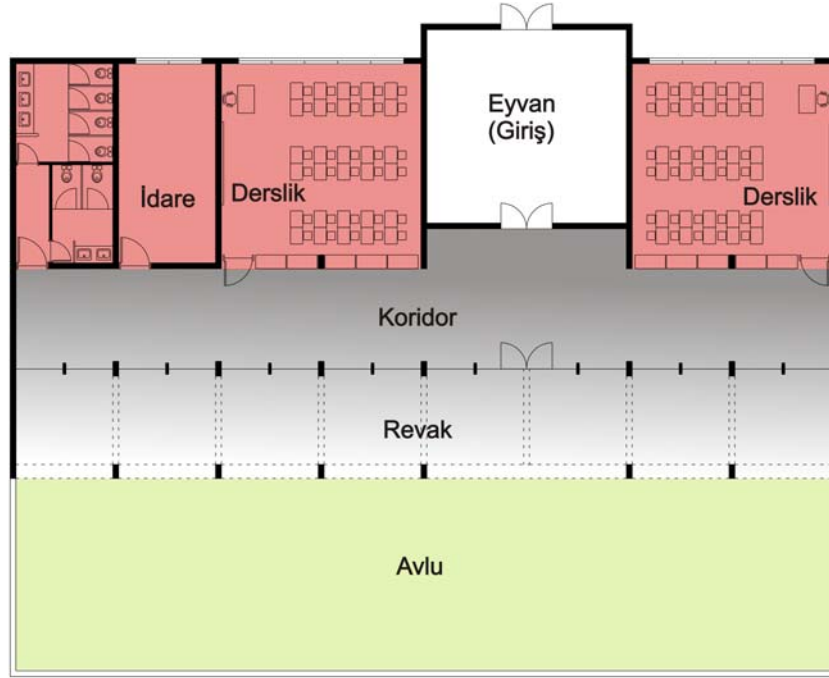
Tek derslikli ilköğretim okulu plan şeması
